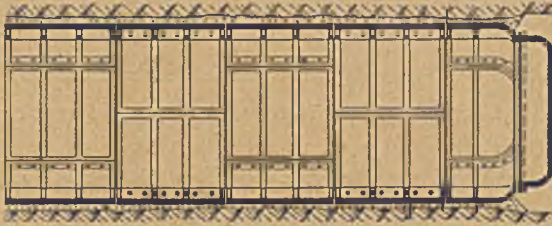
Schematische Darstellung eines eisernen Dammausbaues.
